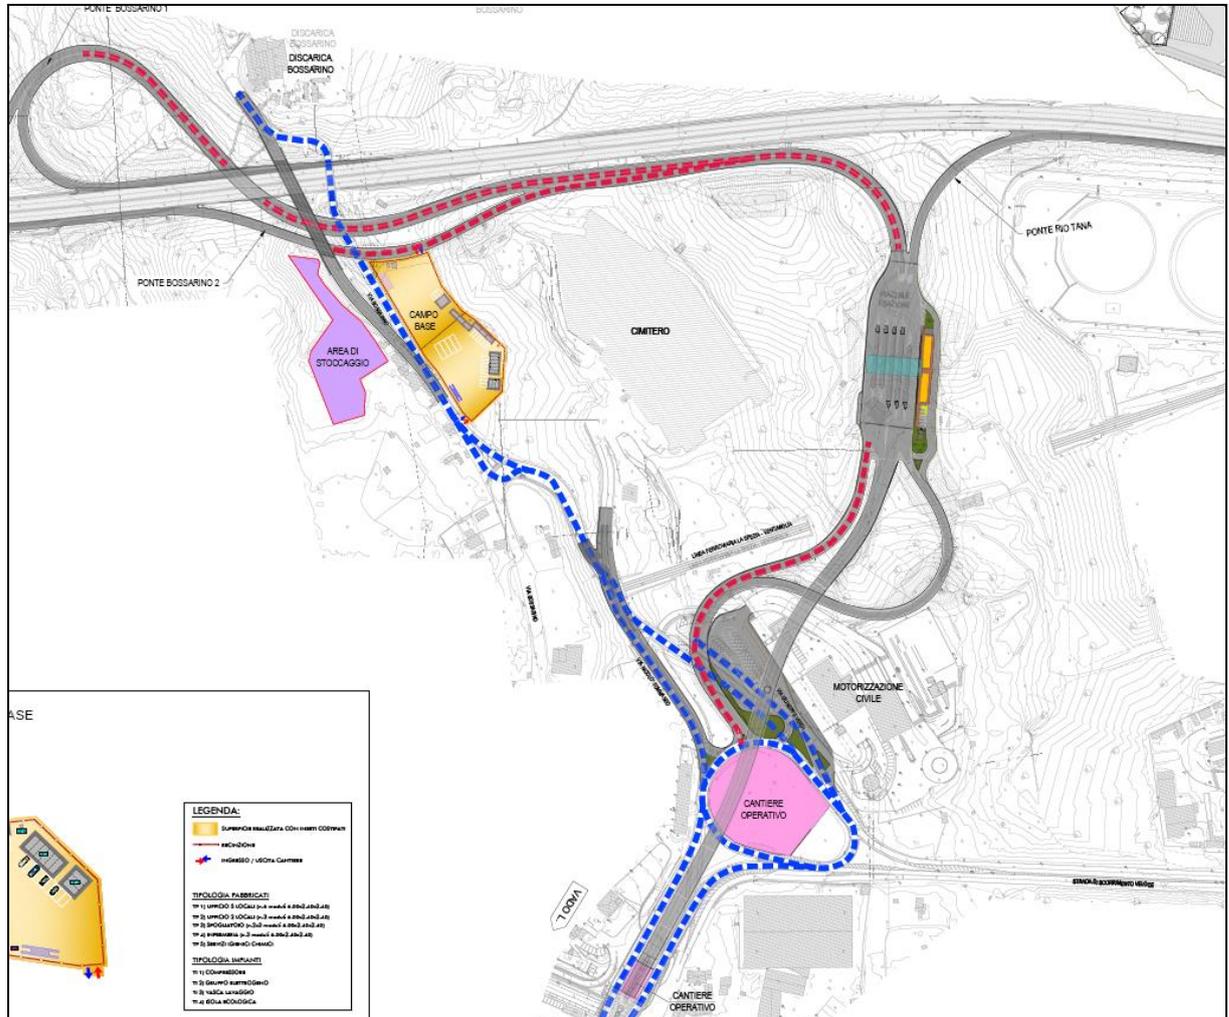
Stralcio dalla planimetria della cantierizzazione.
